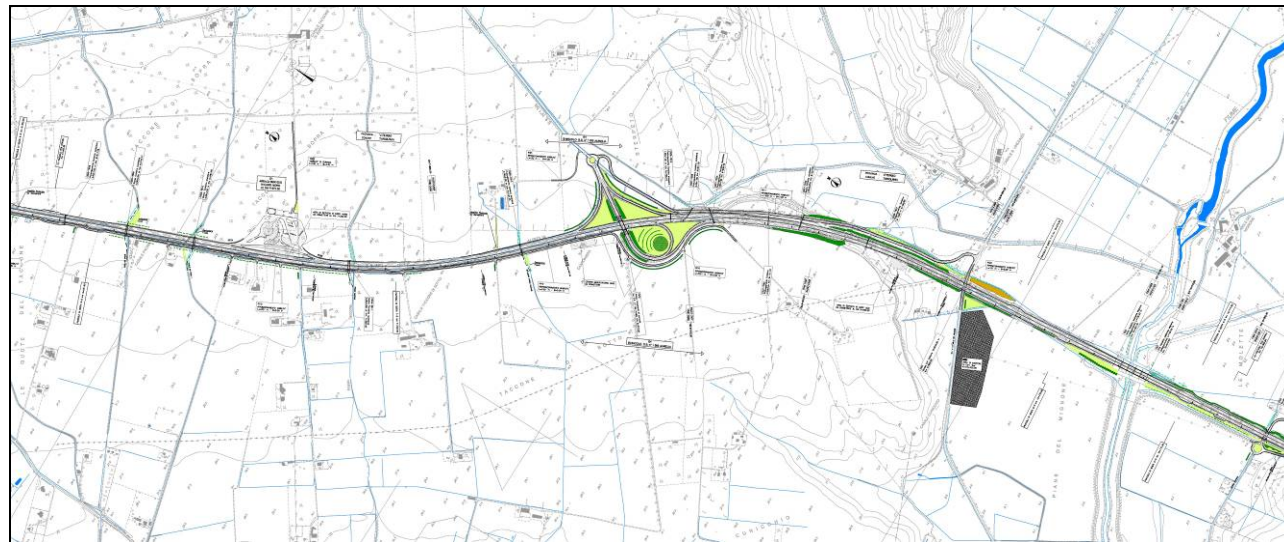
La planimetria del progetto di inserimento paesaggistico e l'attraversamento del fiume Mignone.
